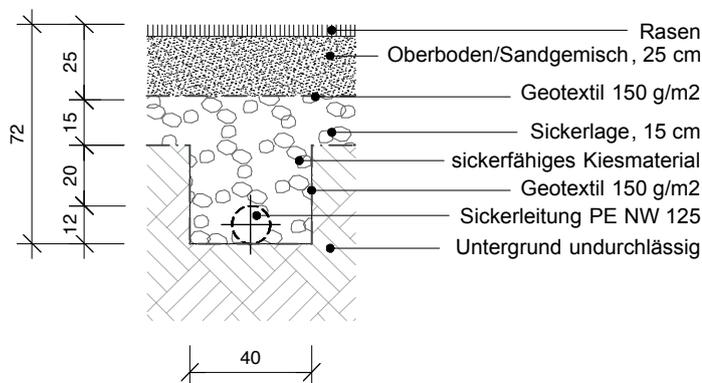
Sickerleitung und Flächendrainage bei undurchlässigem Untergrund
